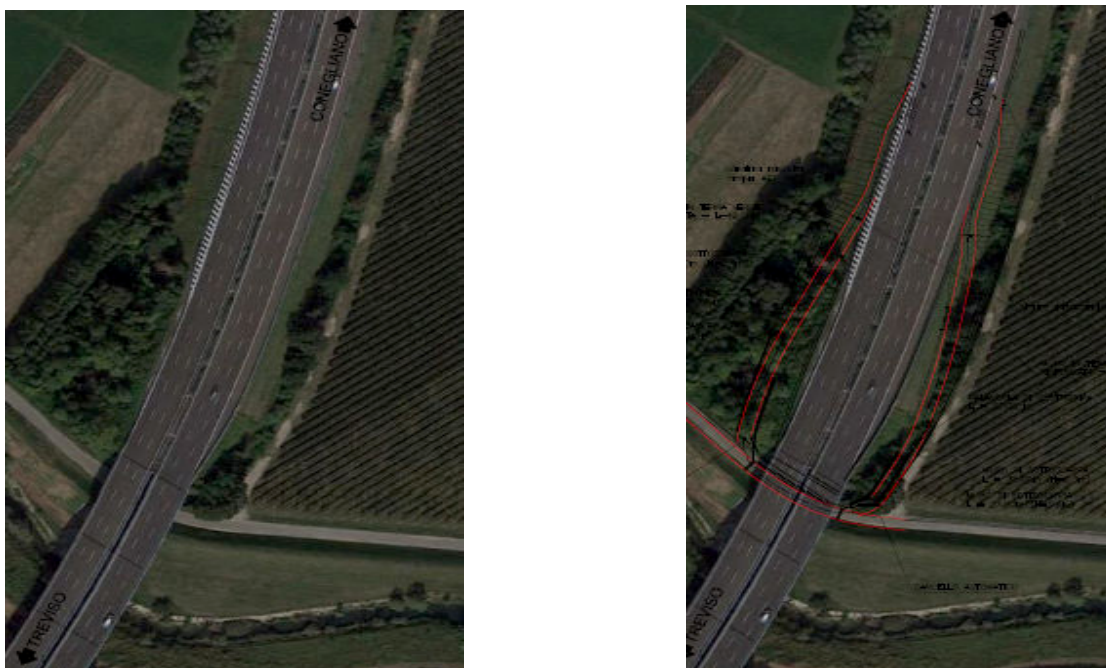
Raffronto stato di fatto e stato di progetto (Fonte: planimetria su foto aerea All. 7 alla lista di controllo)
